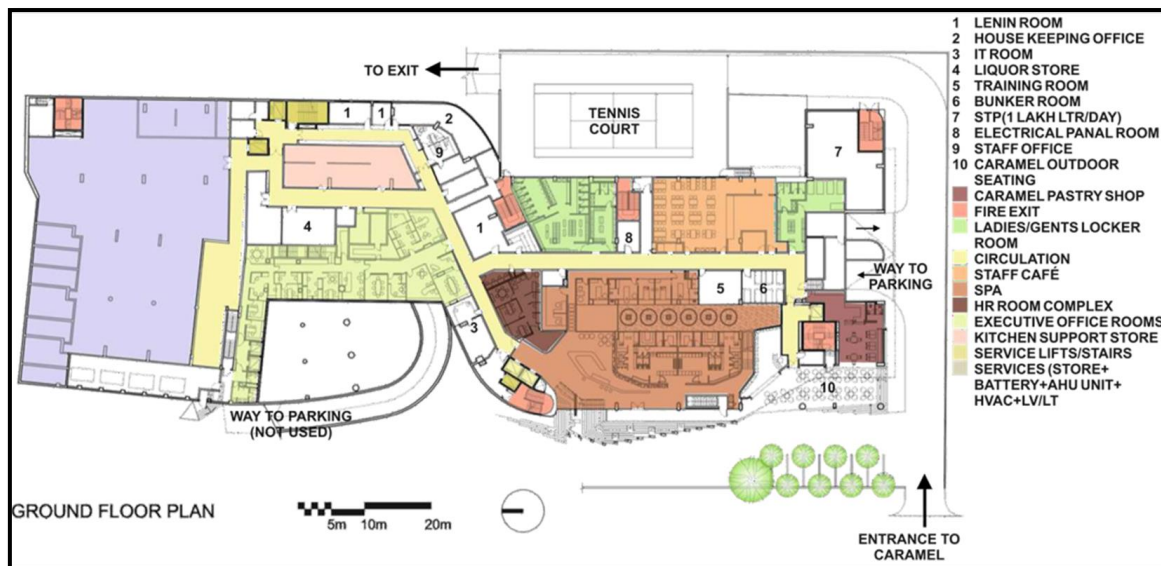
Plan du rez de chaussée Hôtel Vivanta
